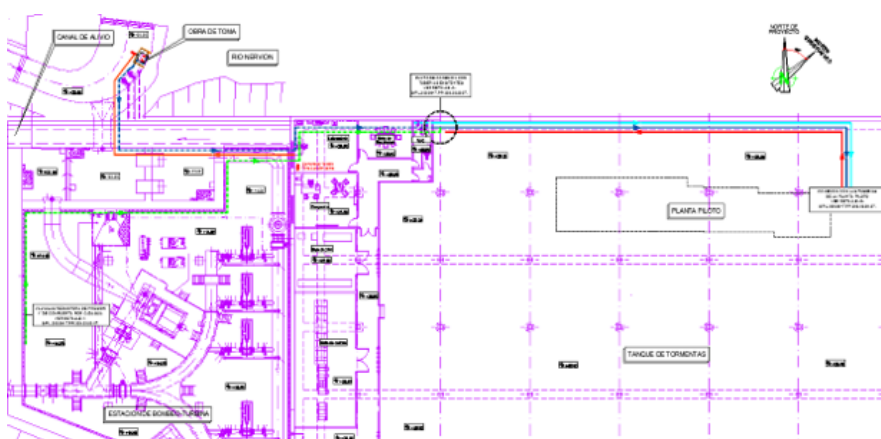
Plano con el recorrido de los servicios que abastecen a la planta piloto, en la ubicación actual
